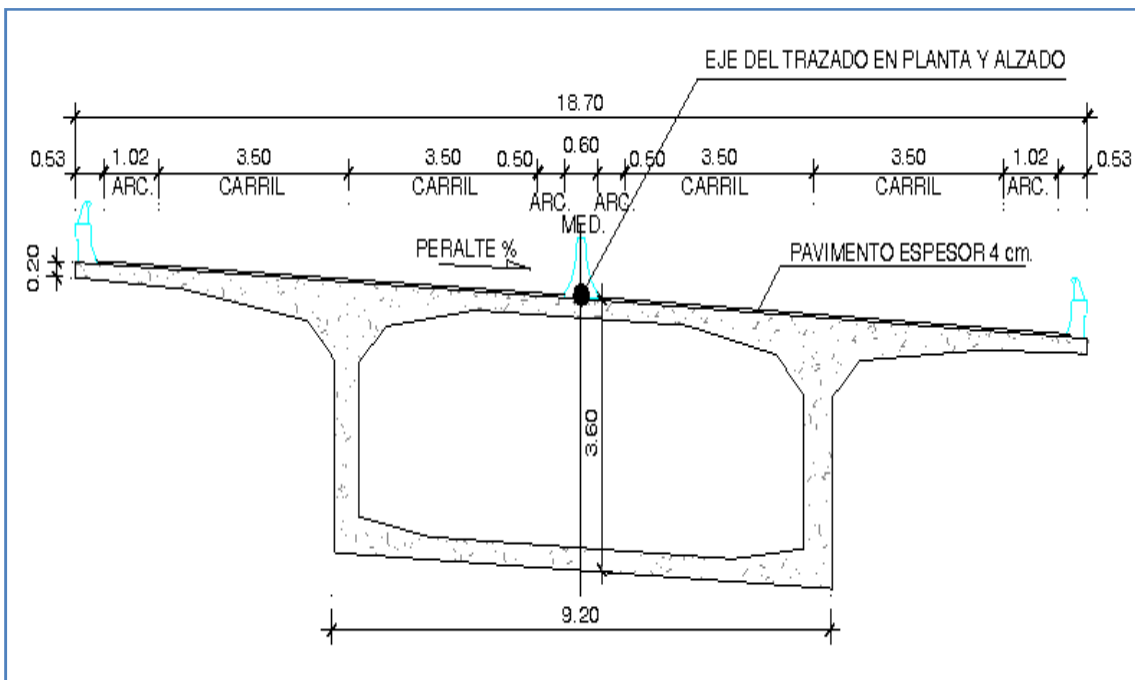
CORTE TRANSVERSAL CENTRO VANO.
